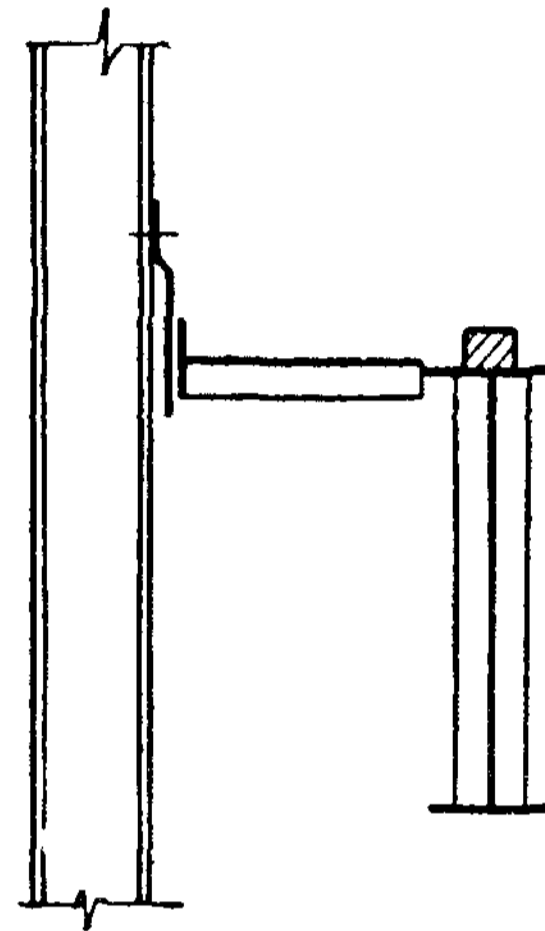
Подвеска пояса тормозной балки при помощи листового шарнира
